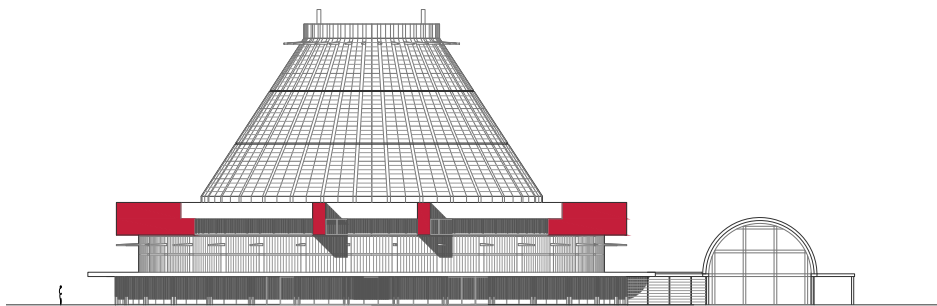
Progetto del teatro del Parco delle arti di Jesolo: Prospetto lato Piave
